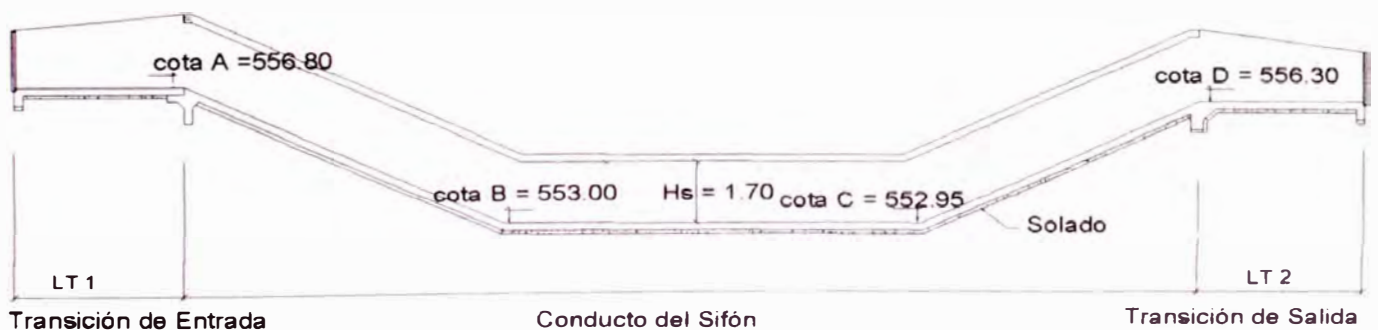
Sección Longitudinal del Sifón N° 1
